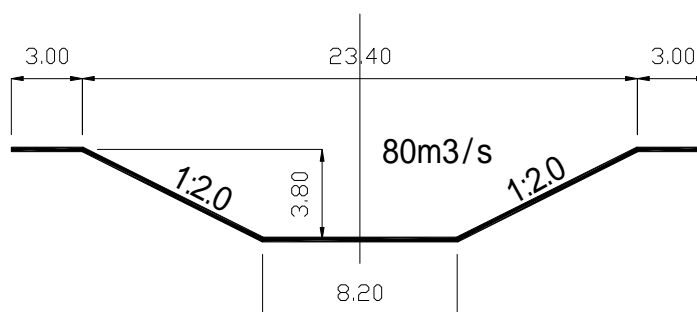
タマラテ放水路計画標準断面図 (Follow-up)
